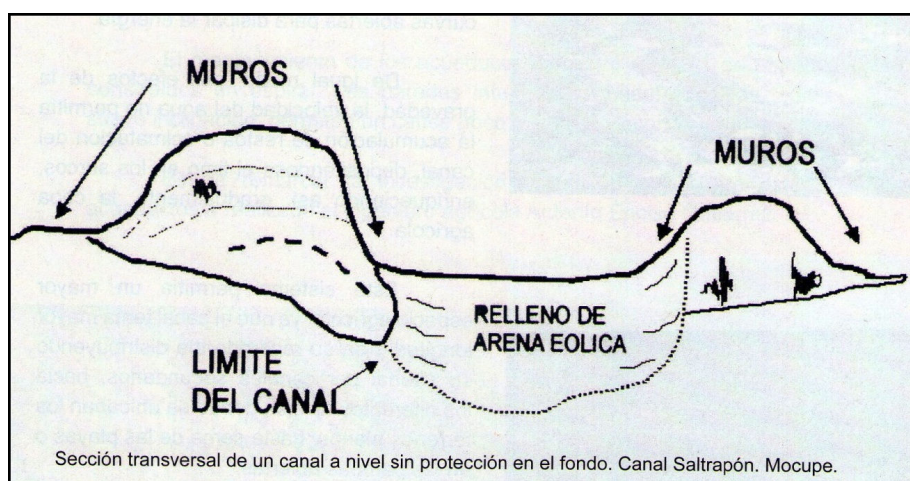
Sección transversal de un canal a nivel sin protección en el fondo. Canal Saltrapón. Mocupe.<sup>17</sup>
